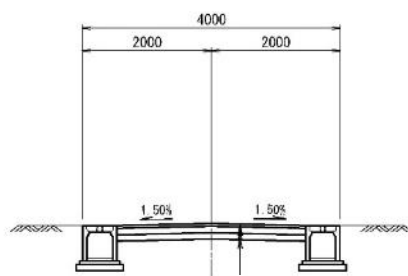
(10) 標準断面図 (特殊道路 幅員 4.0m)
